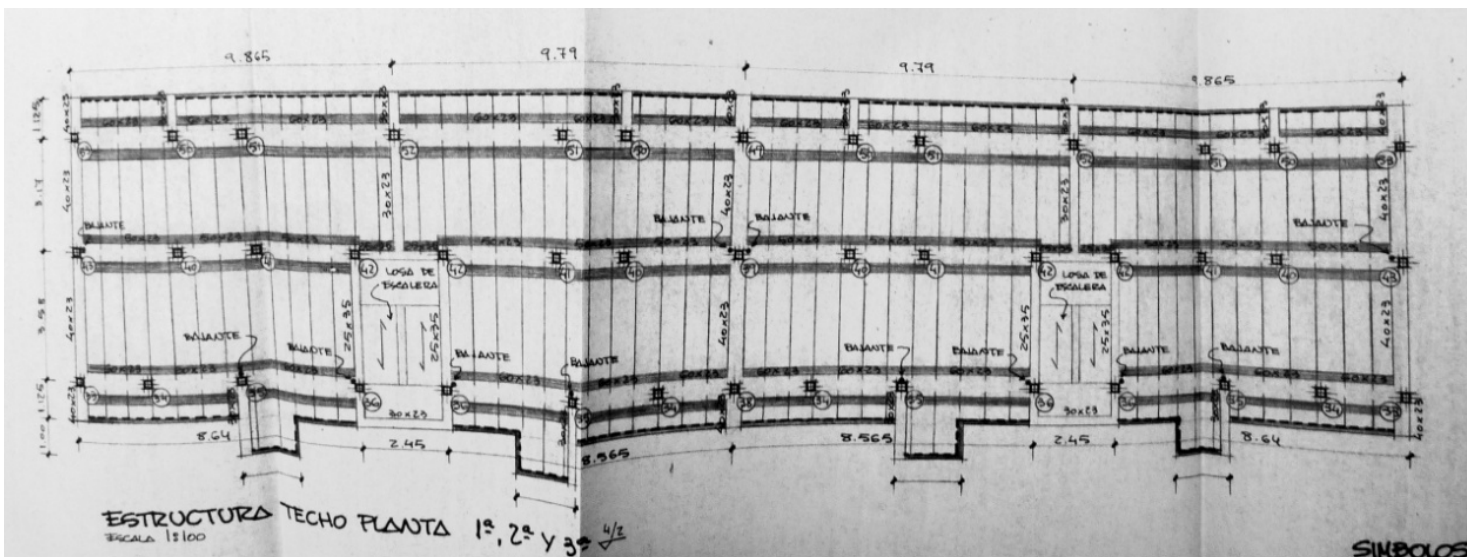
Planta de forjado en el edificio de la calle Jardineros.
